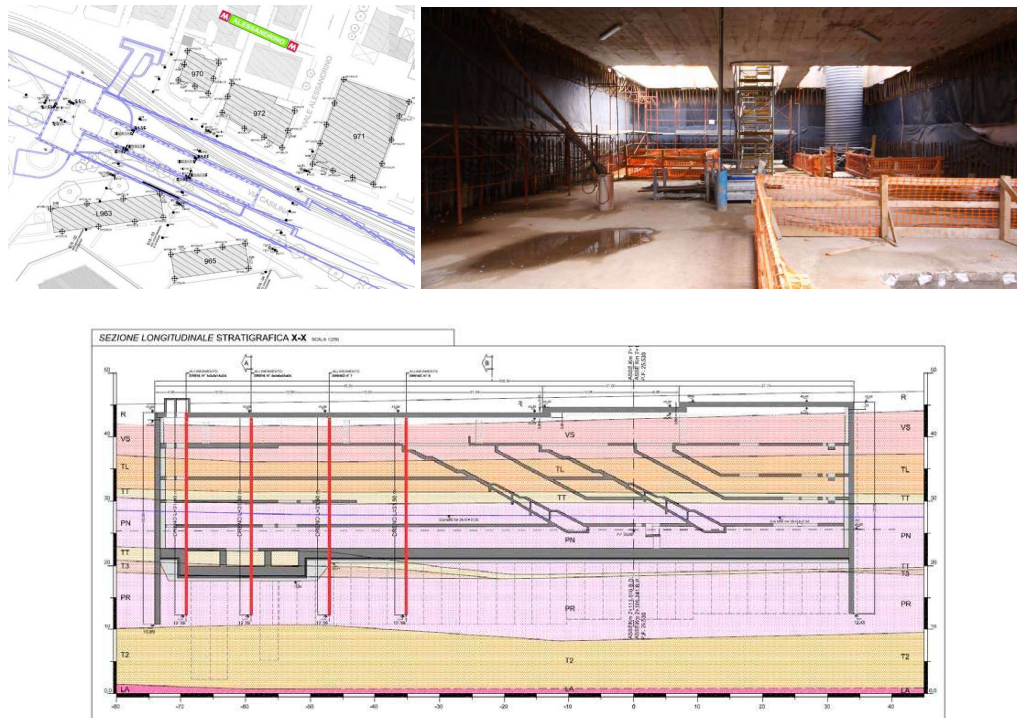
Stazione Alessandrino a) Planimetria e veduta di insieme b) Sezione geotecnica longitudinale
